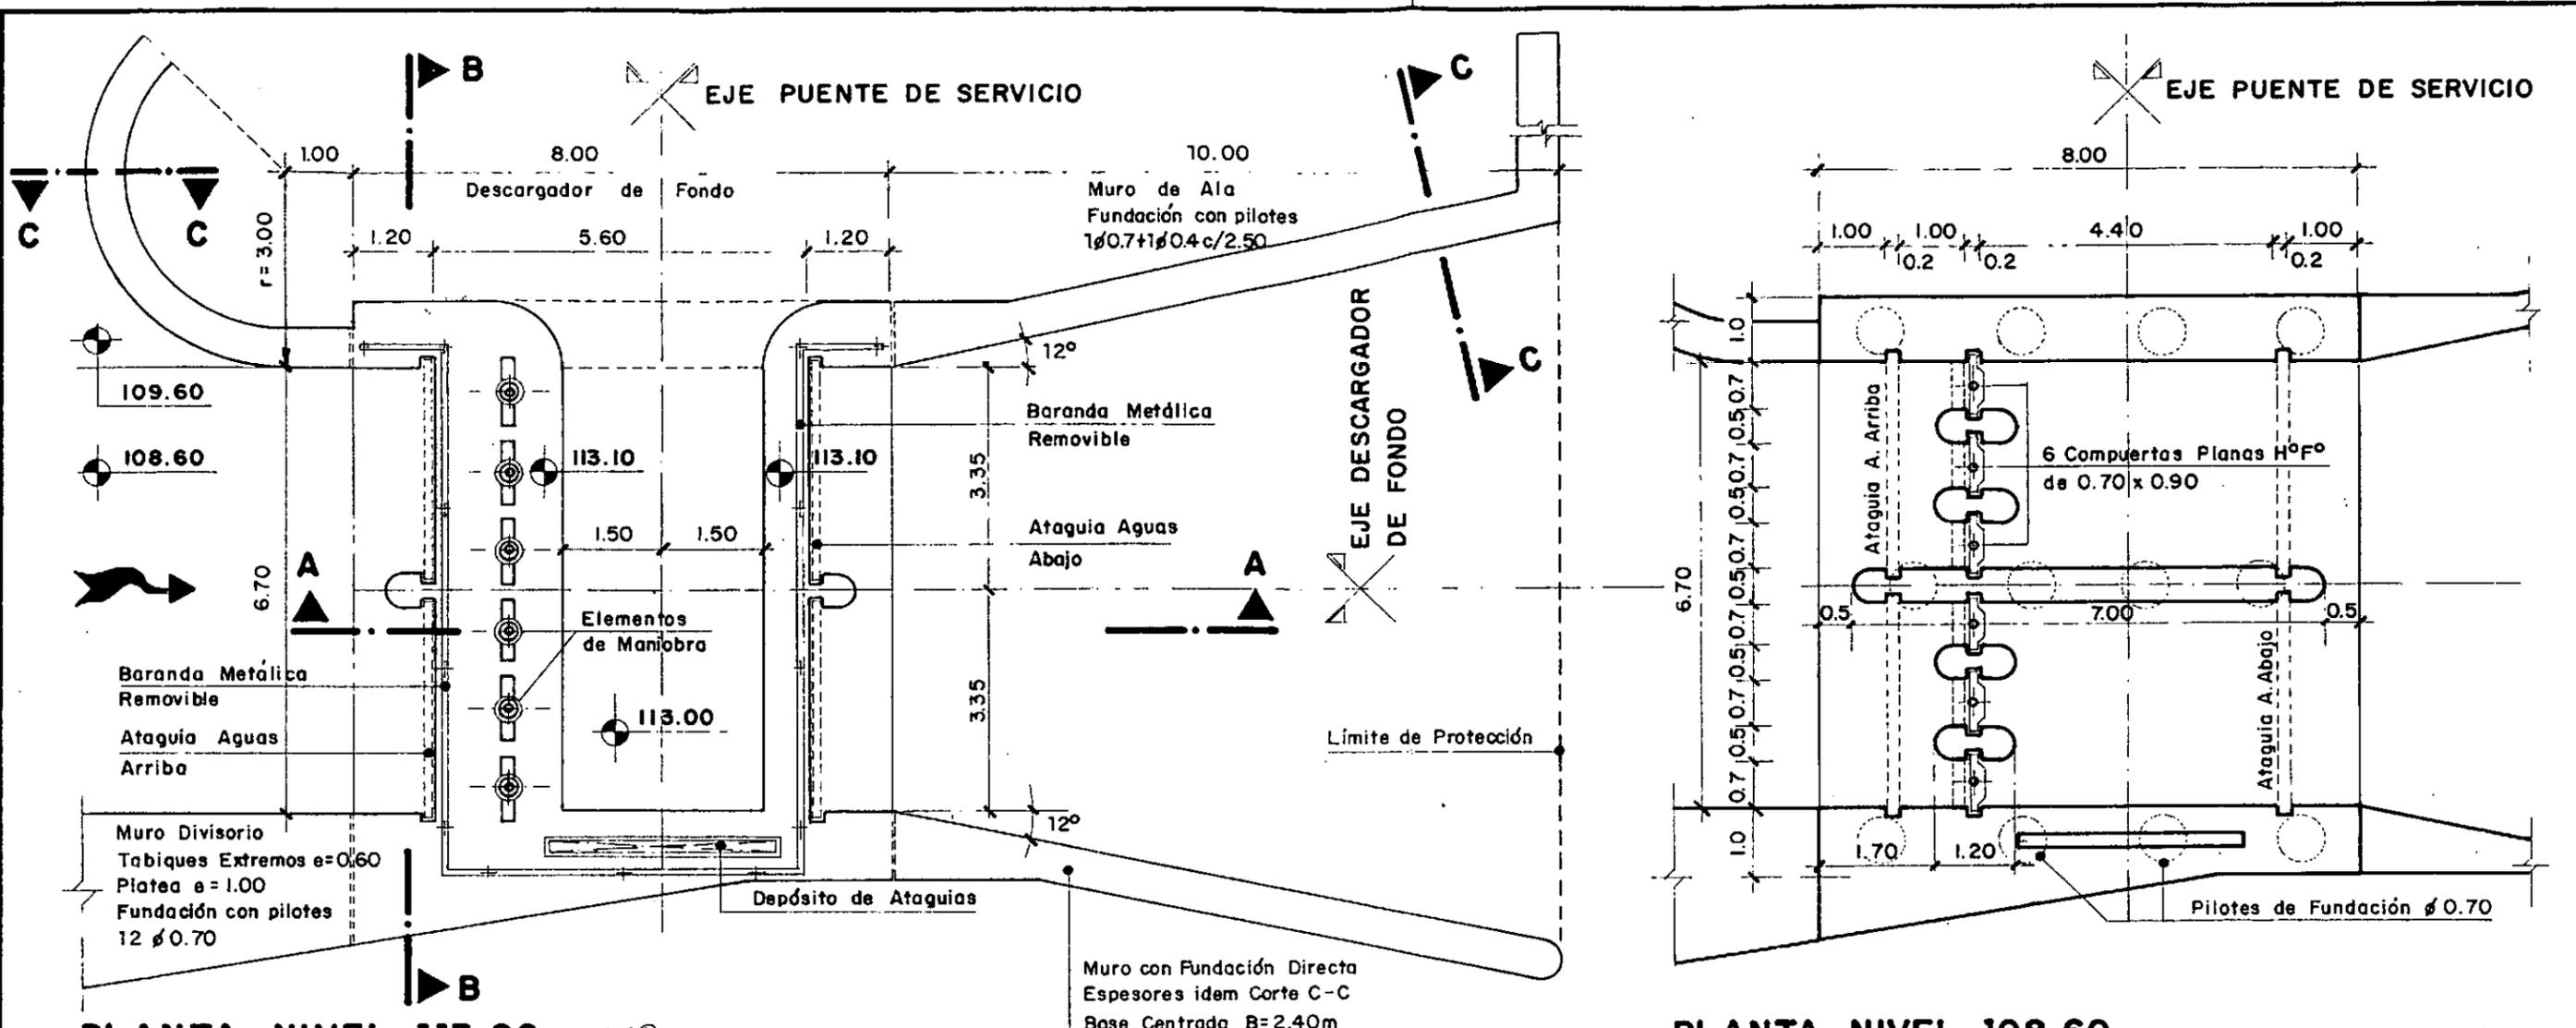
DISPOSICION GENERAL DE OBRAS
